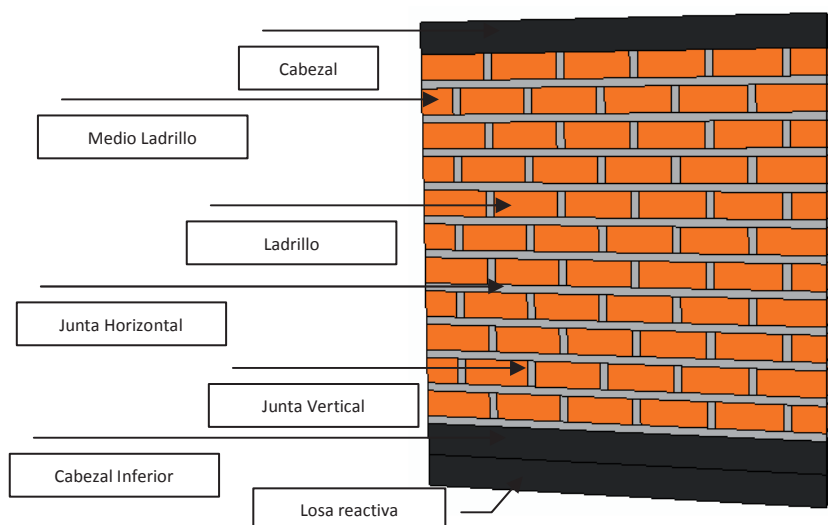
Modelo de murete utilizado con mallado para FEM
